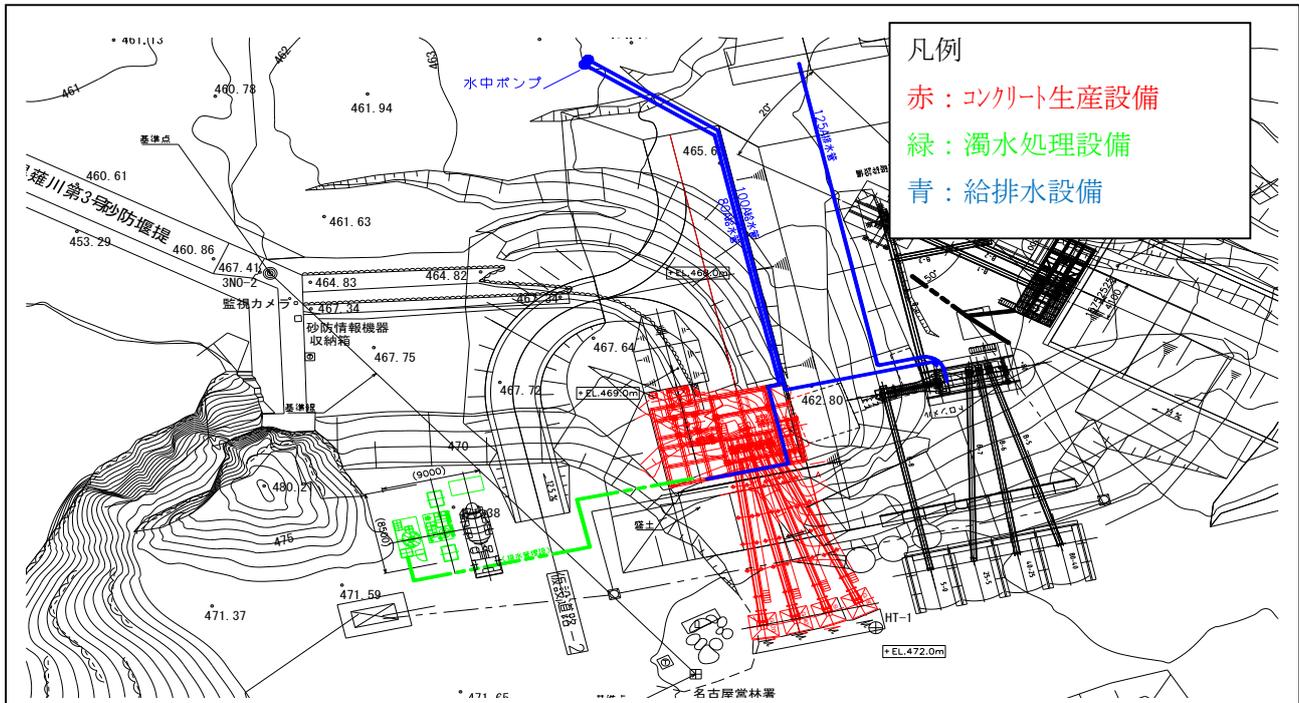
コンクリート生産設備、濁水処理設備、給排水設備配置図
